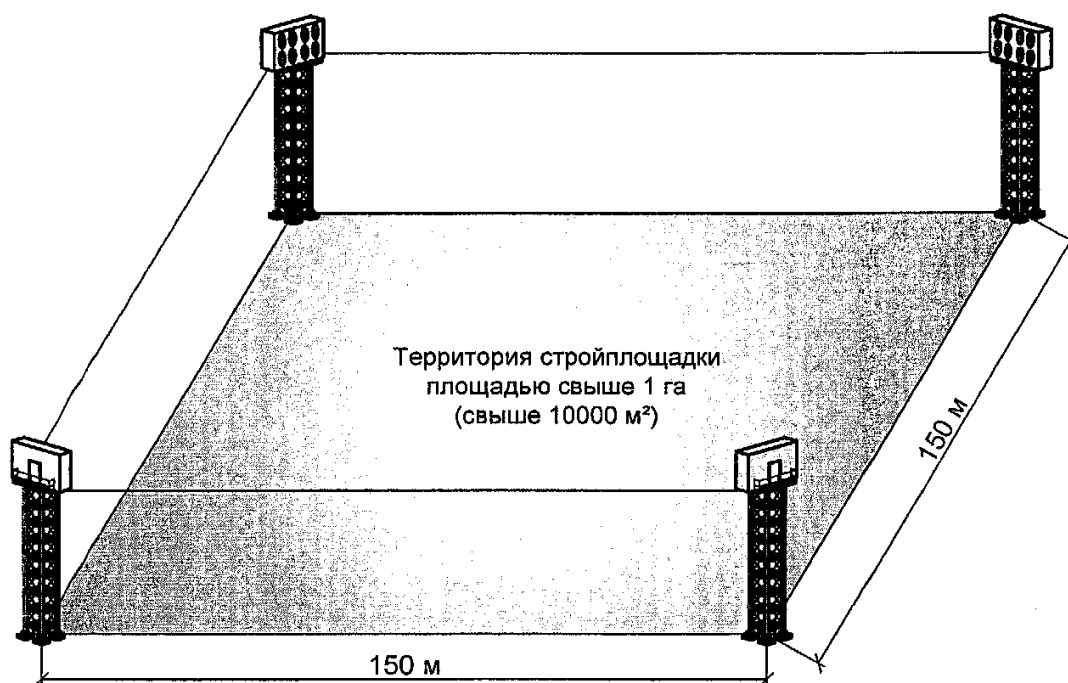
Схема освещения строительной площадки при помощи осветительных (металлических) мачт
